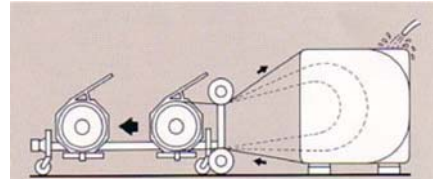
ワイヤーソーによるコンクリート切断のイメージ図
